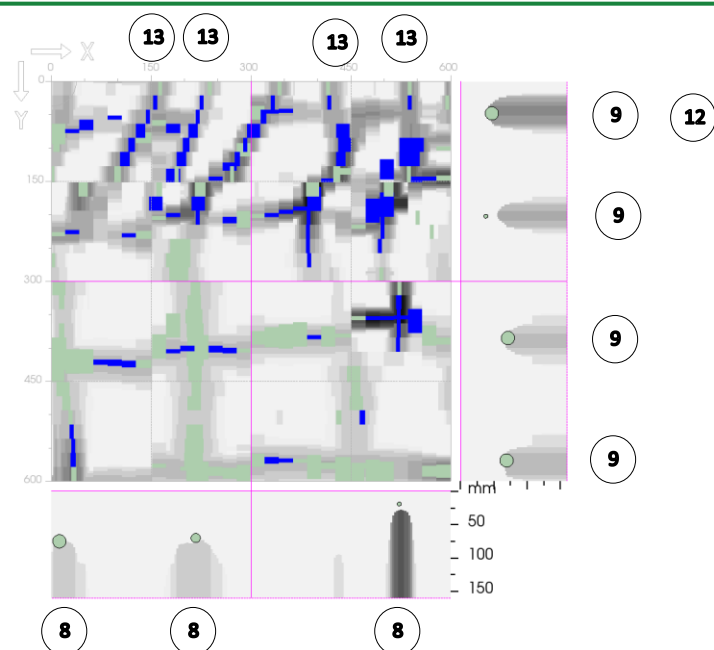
Ferrailage reconnu – Poutre Pt04
